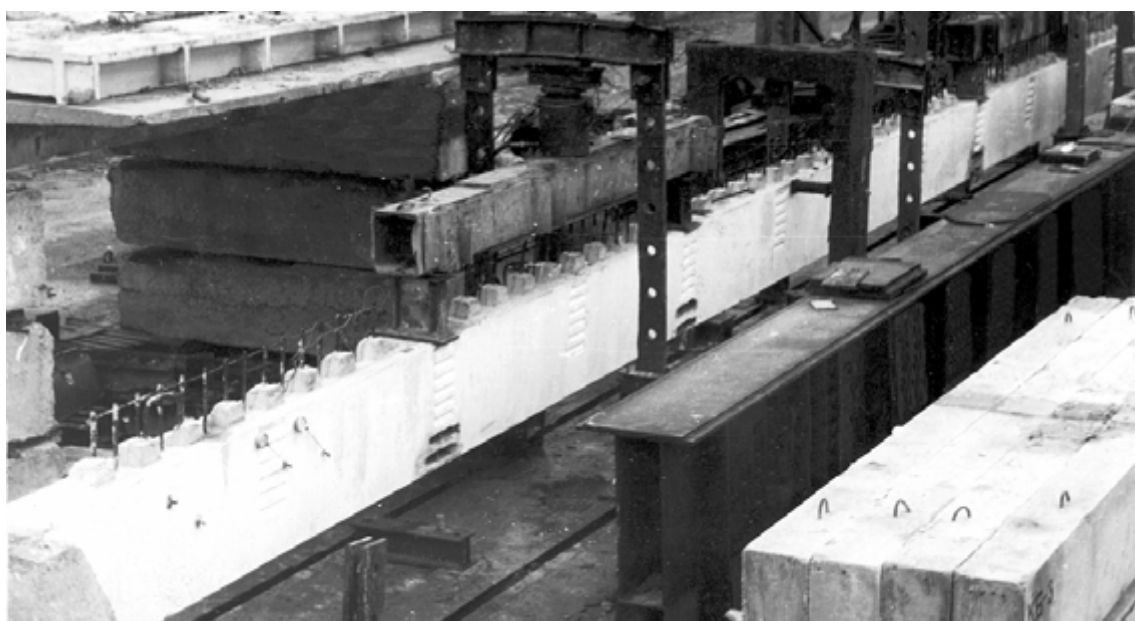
Випробування збірної балки НБПС-18 для збірно-монолітних покриттів на навантаження, що діють у стадії монтажу (п. 13 в табл. 1)
